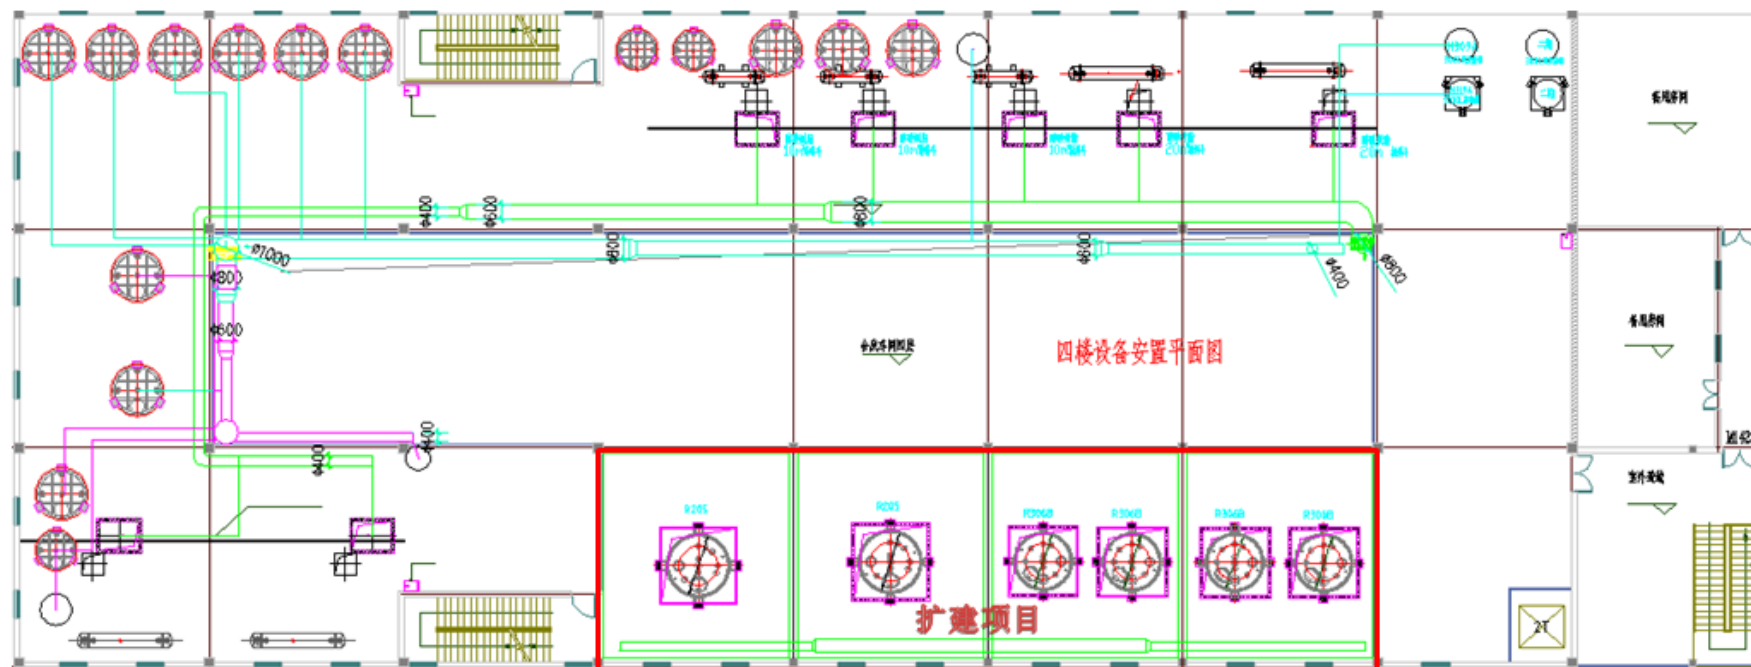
合成车间 4F 扩建项目设备平面布置图
